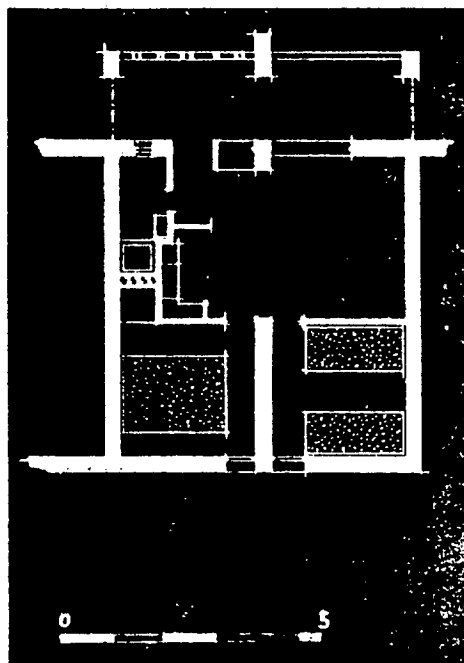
POBLADO DE ABSORCION DE CANILLAS
